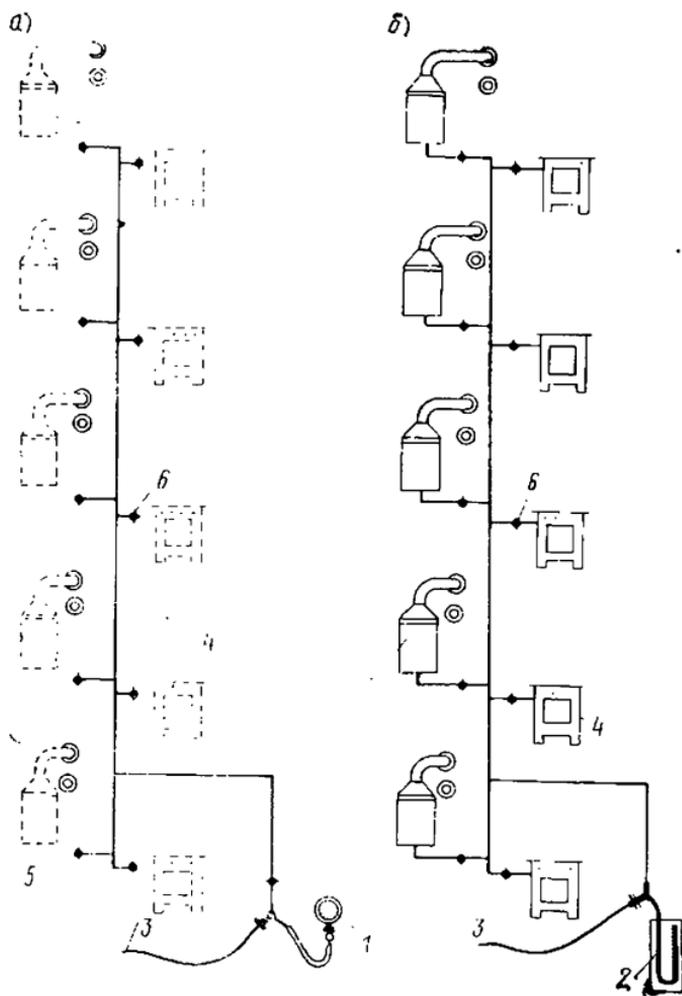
Схема проведения пневматического испытания внутреннего газопровода
